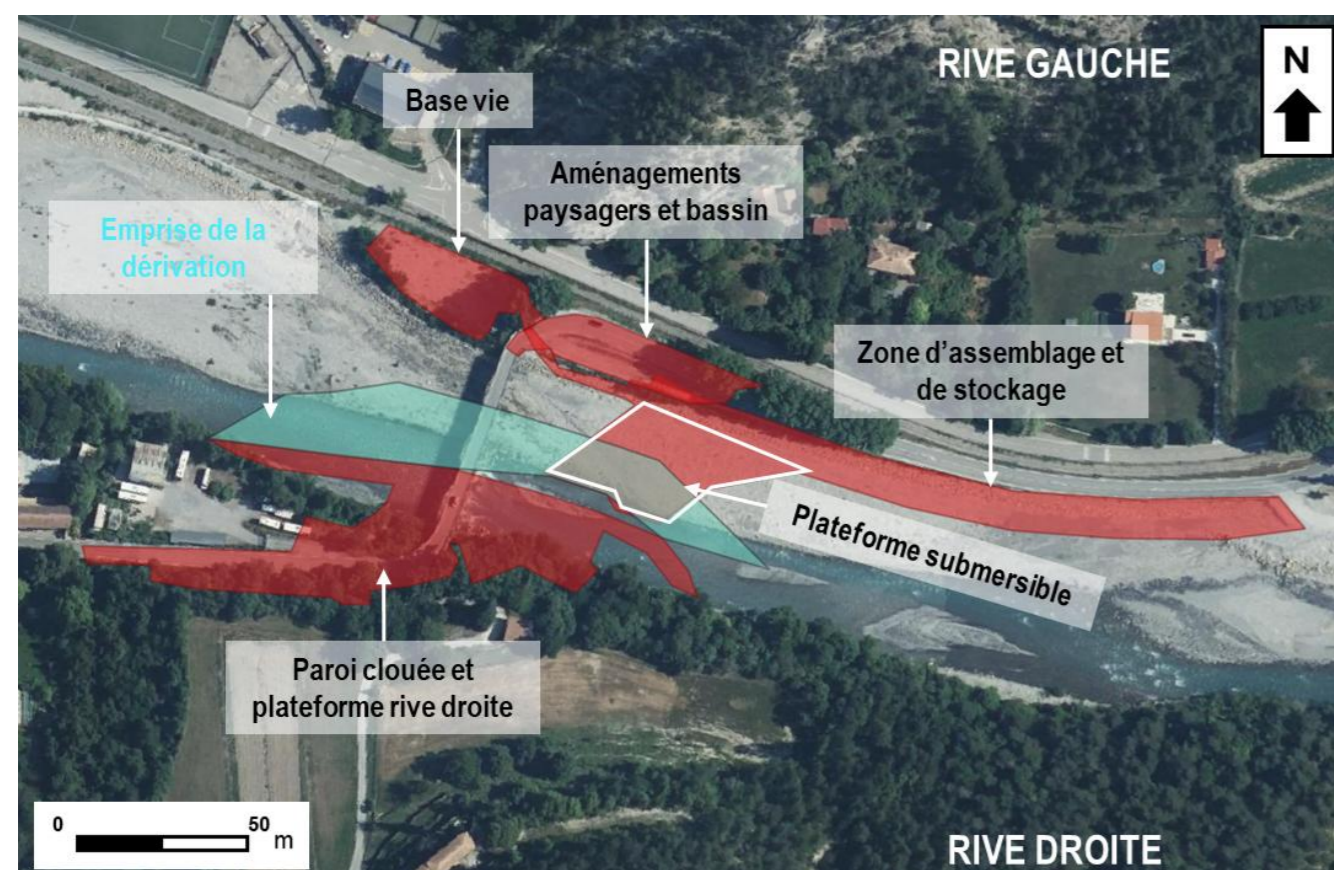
Emprise des travaux de la phase de construction sans la surface de dérivation
